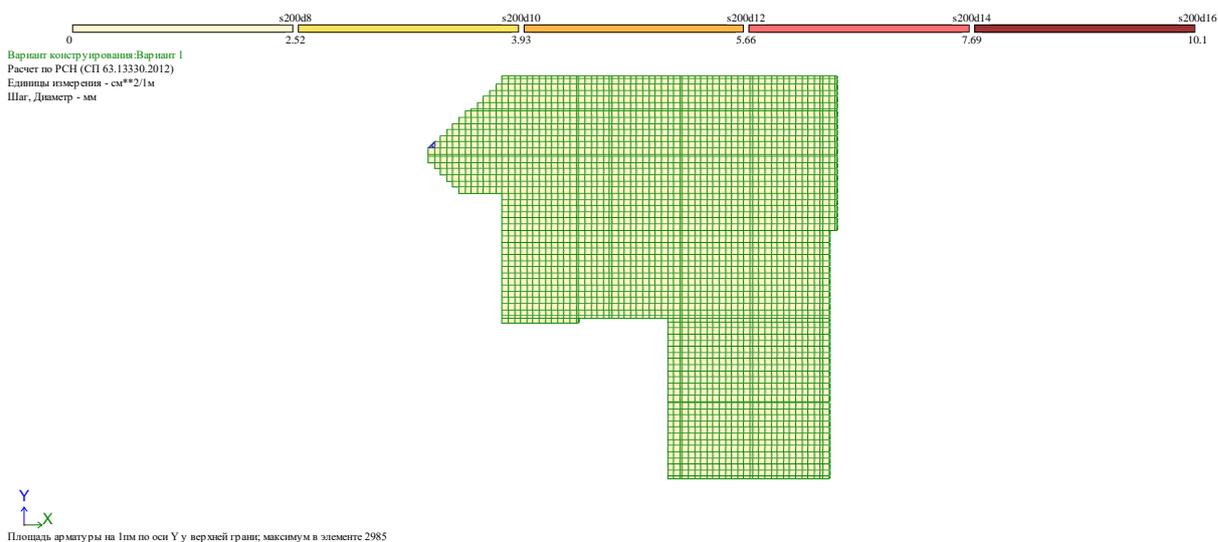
Подбор верхней продольной арматуры плиты по оси Y
